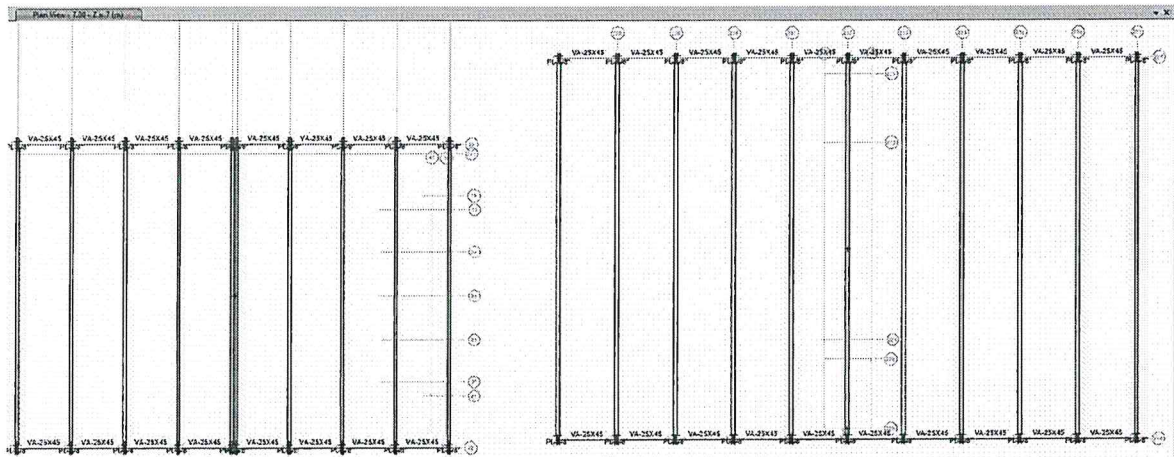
Vista en Planta del modelo estructural de la Edificación 19-20 sistémico analizado. Los elementos no estructurales fueron ingresados como cargas permanentes
